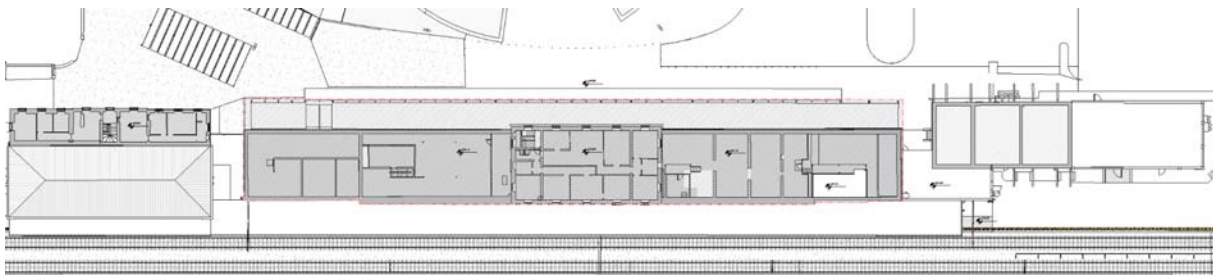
Planimetria piano terra e piano primo con destinazioni d'uso
